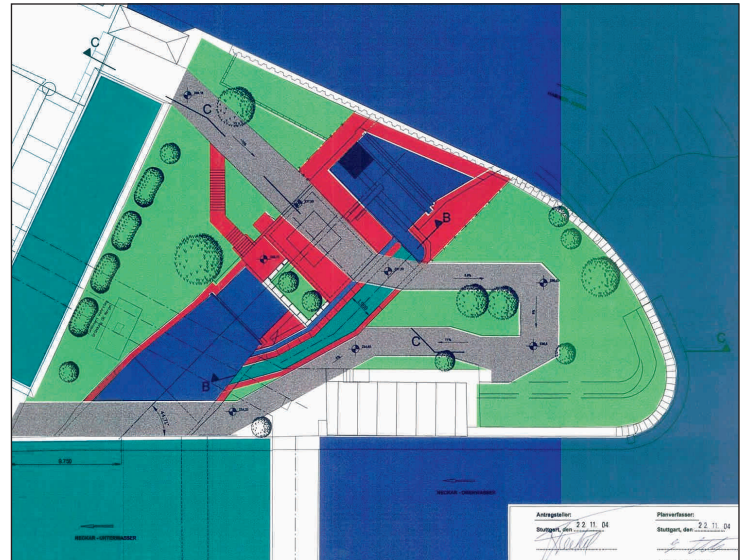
Lageplan Wasserkraftanlage, Staustufe Esslingen
